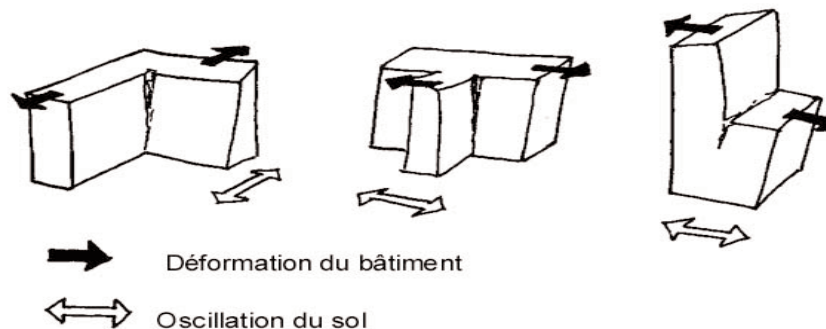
Dommages dus à la forme architecturale du bâtiment
